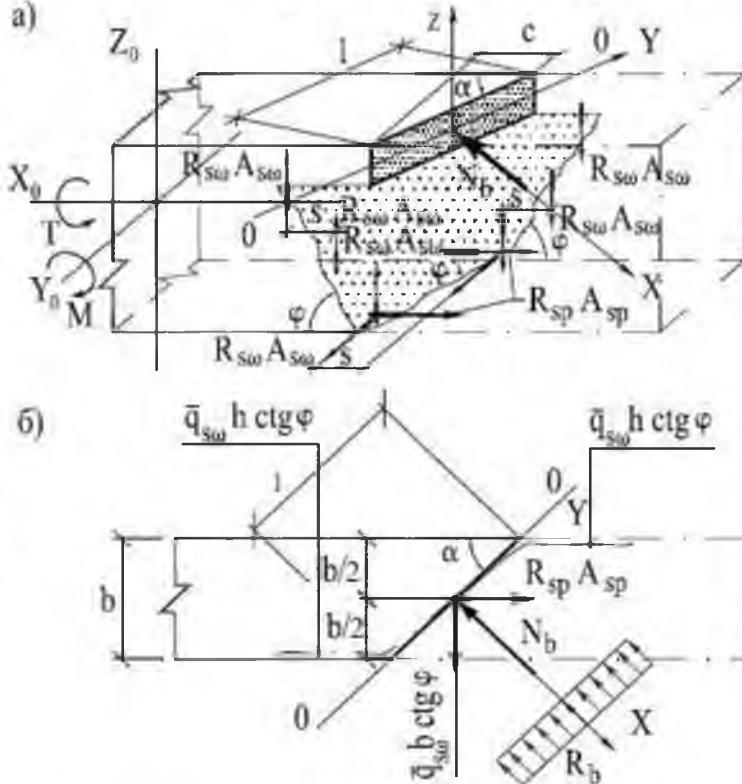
Розрахункова схема для визначення несучої здатності попередньо напружених залізобетонних конструкцій при крученні зі згином
